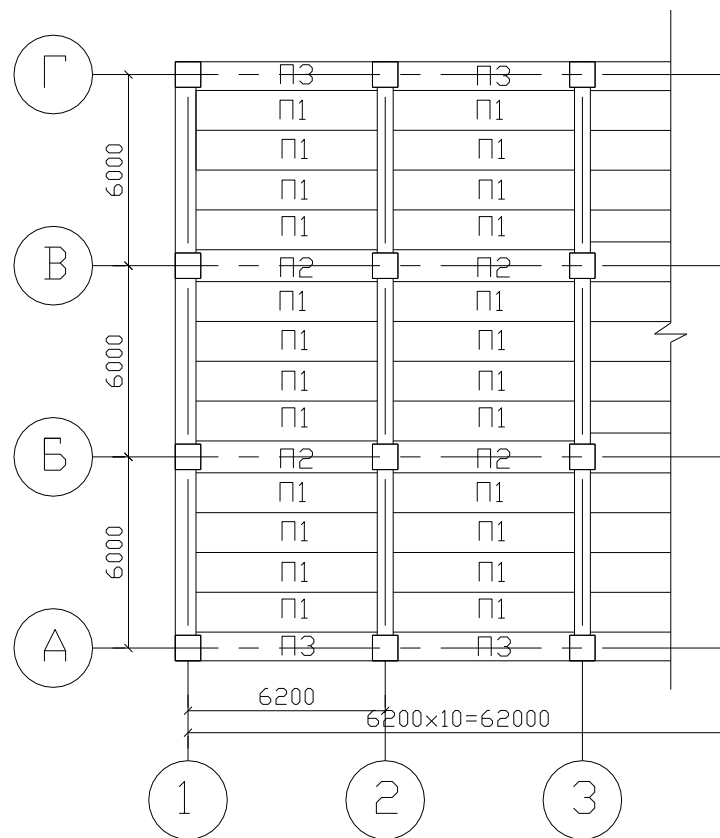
Схема расположения ригелей и плит перекрытия
